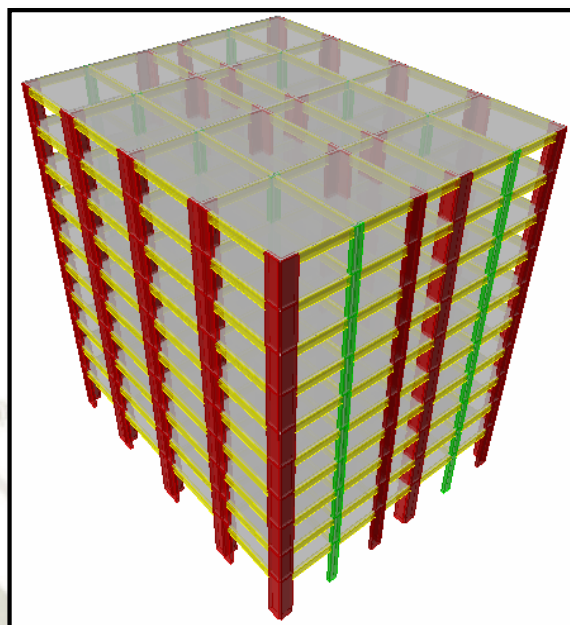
Modelo estructural del Sistema de muros de concreto armado realizado en el programa computacional ETABS 9.7.4. (Fuente: Elaboración propia)
